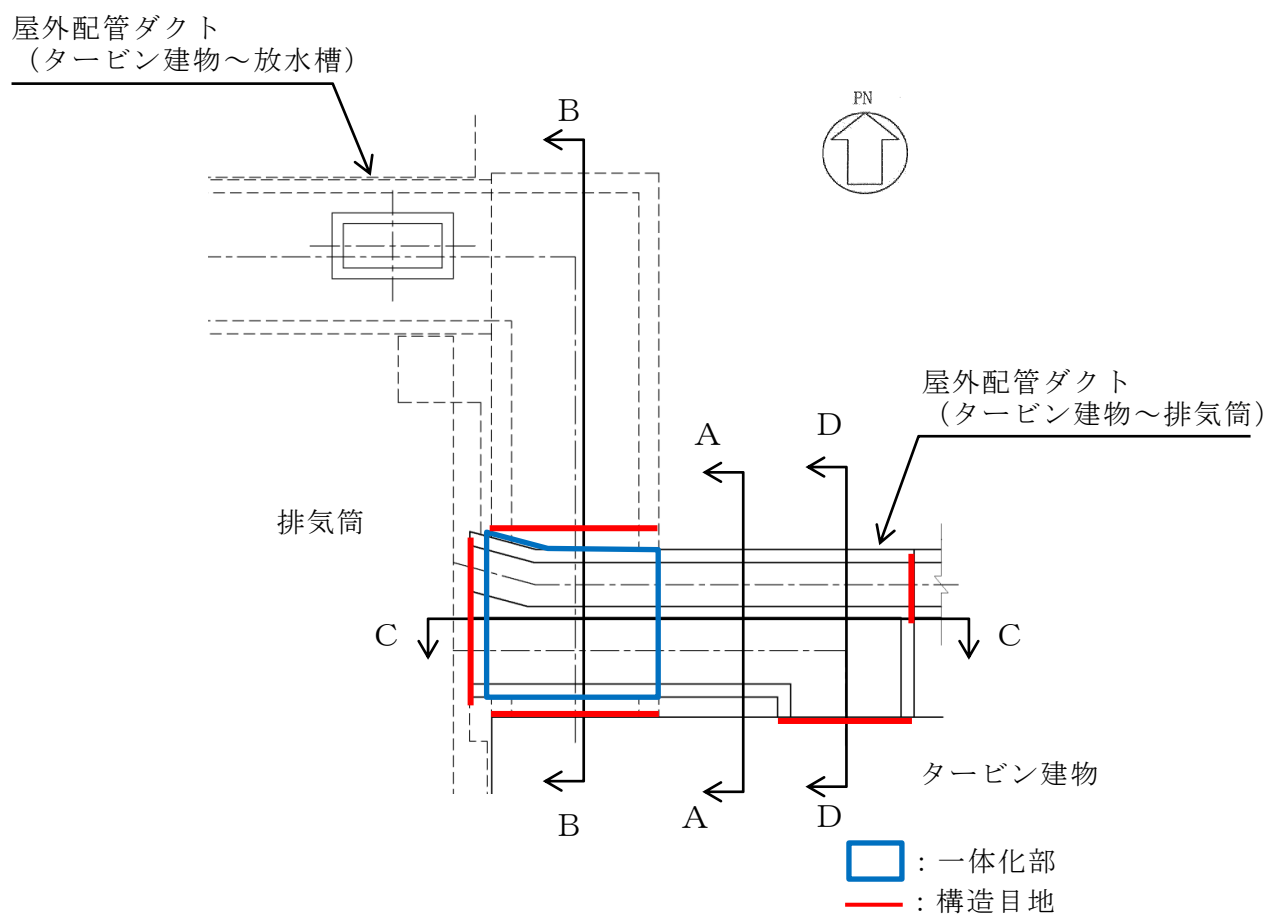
屋外配管ダクト (タービン建物～排気筒) 平面図
